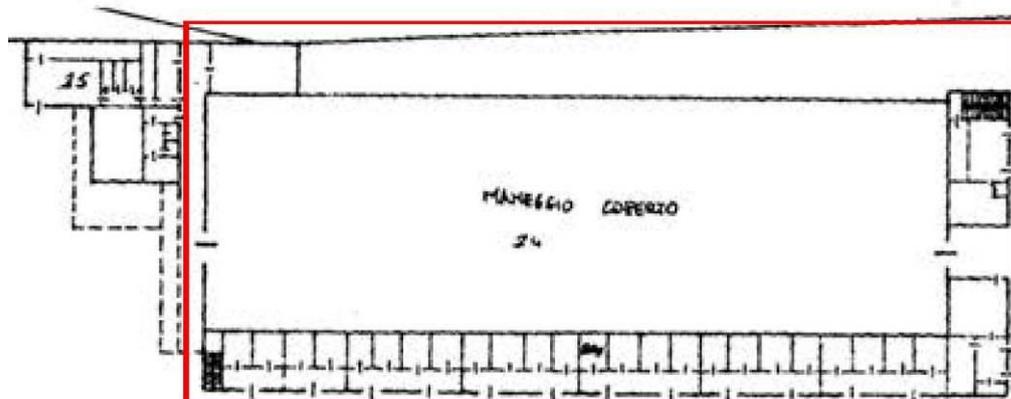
Planimetria Piano terra Maneggio, scuderie e uffici
